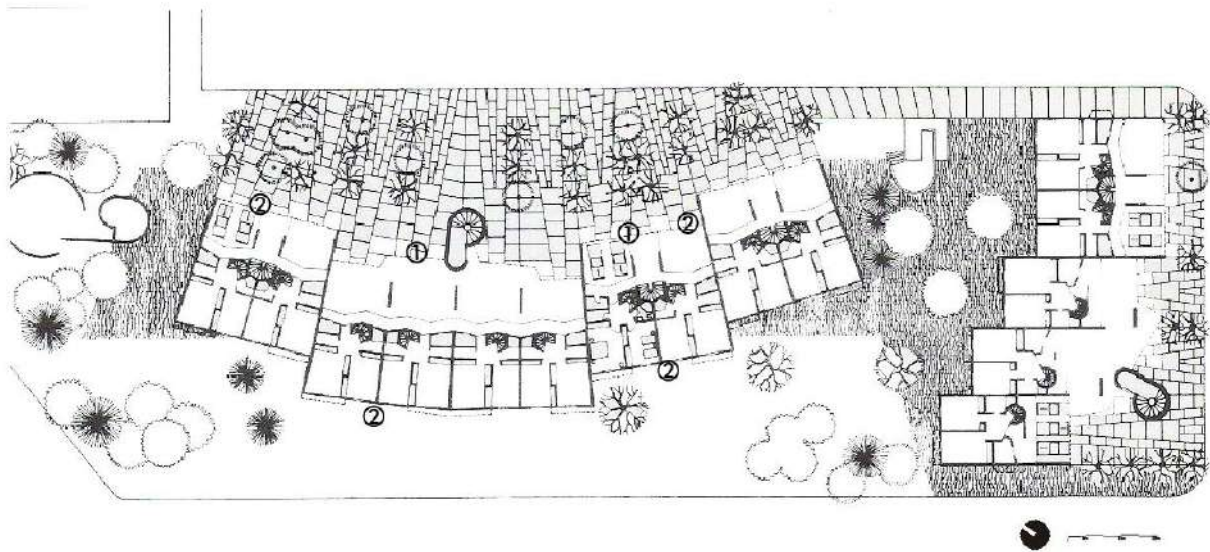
Localización de patologías en planta Torres del Parque. Planimetría general, Fuente: Archdaily (2011). Edición: La Autora (2021).
